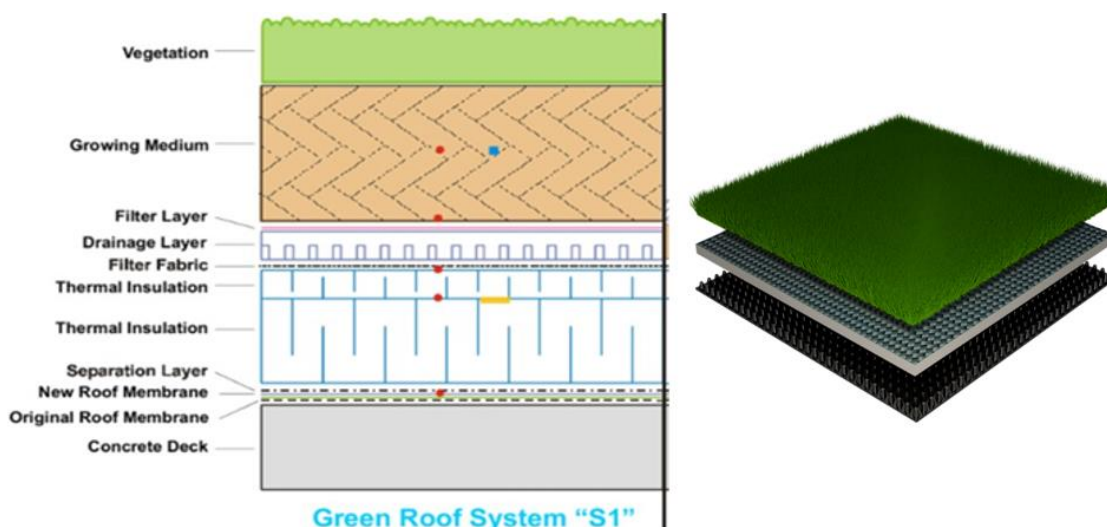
Capas la cubierta convencional y el techo verde. Obtenido de (PRASPAN., 2026)
